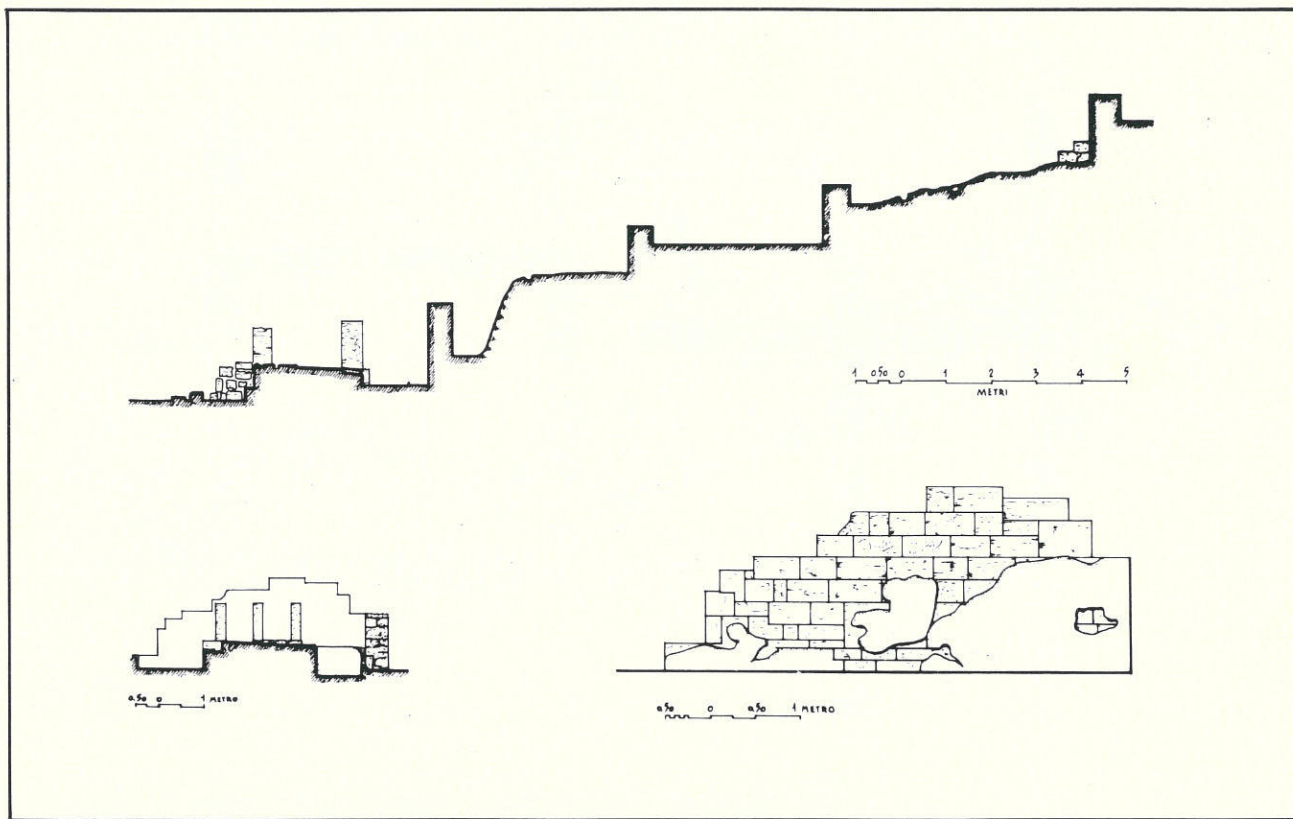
Sezione Est-Ovest degli edifici A-B; Sezione Nord-Sud del vano a e muro Ovest M 1 (da Tusa, 1966).
